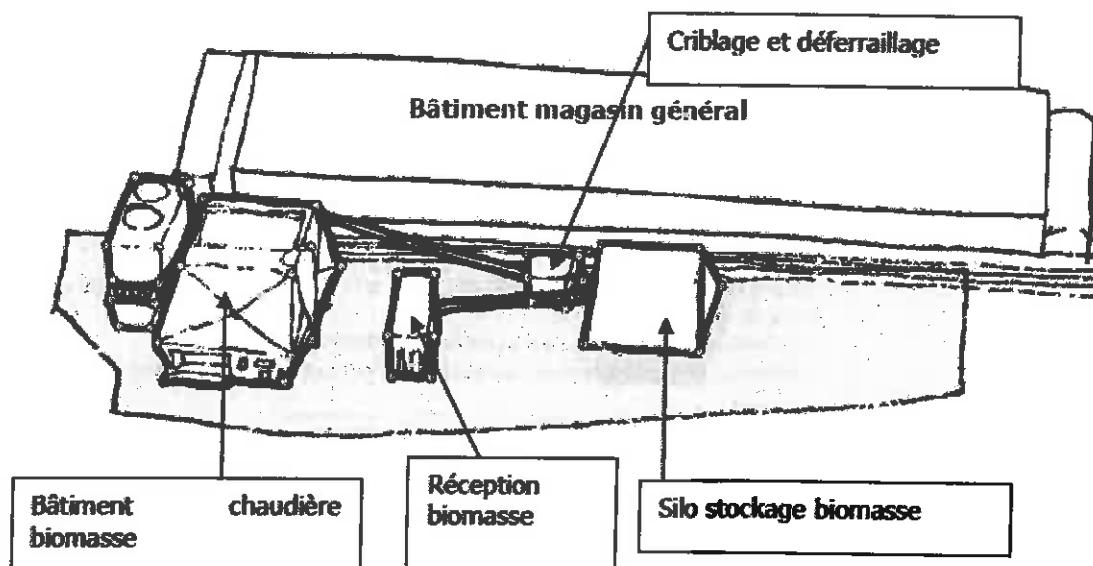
PLAN SCHEMATIQUE DES INSTALLATIONS (SOURCE : DALKIA FRANCE)
